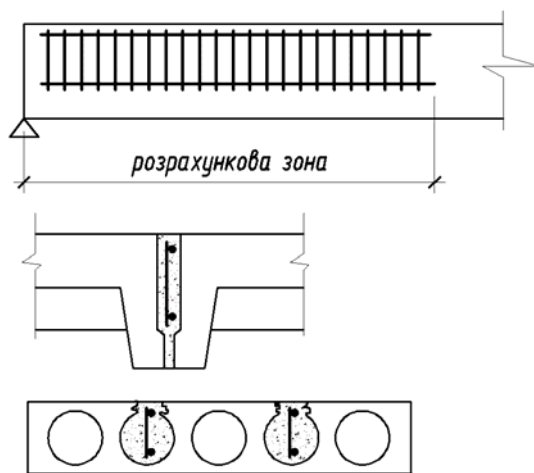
Підсилення плит каркасами по похилому перерізу: а – поздовжній переріз; б – установка каркасів у швах; в – установка каркасів у порожнечях
